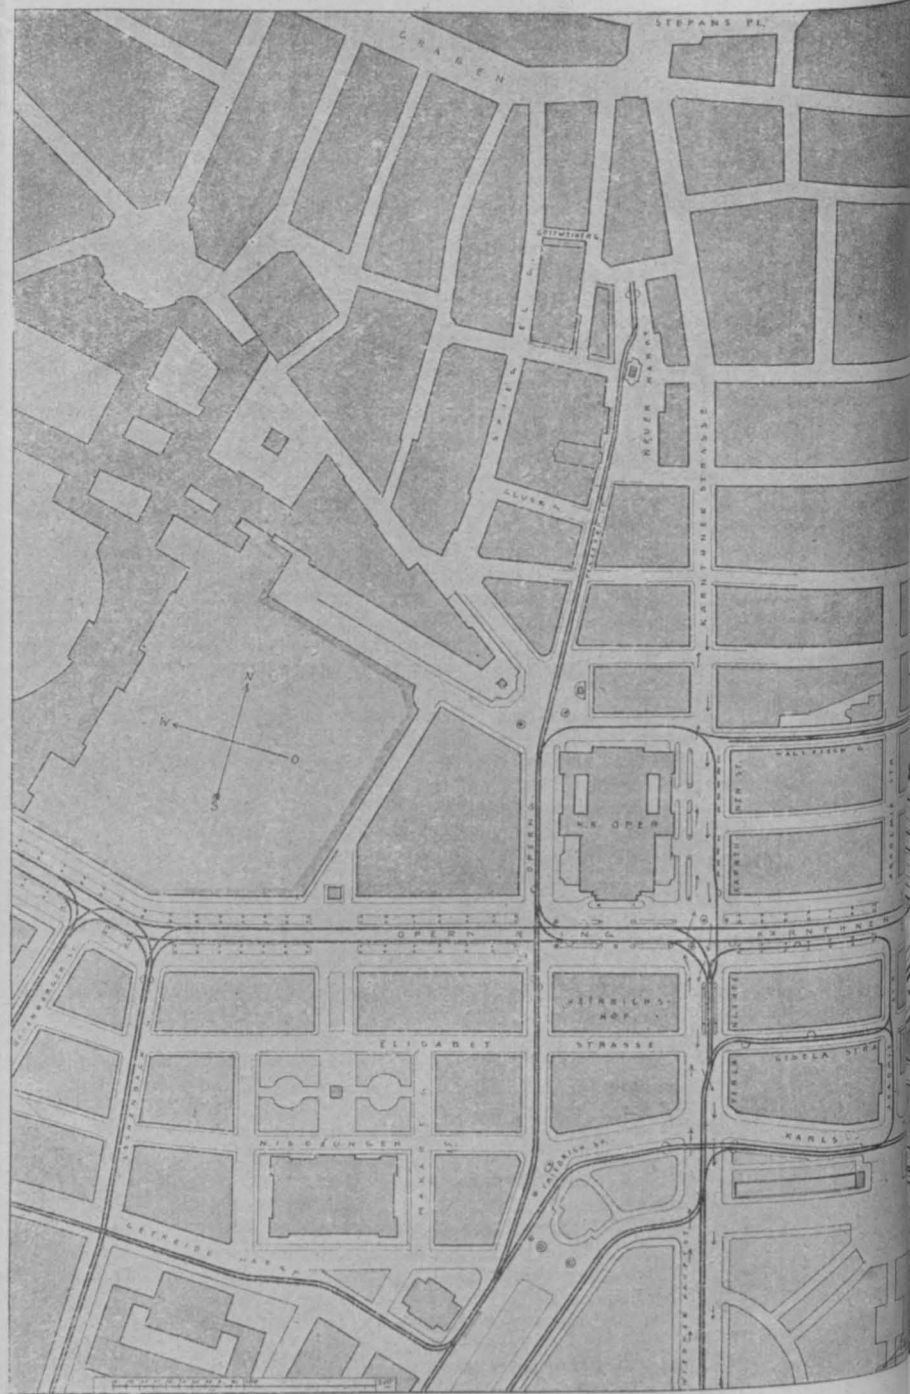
Plan der bestehenden Straßenbahnanlage am Opernring und Umgebung.
